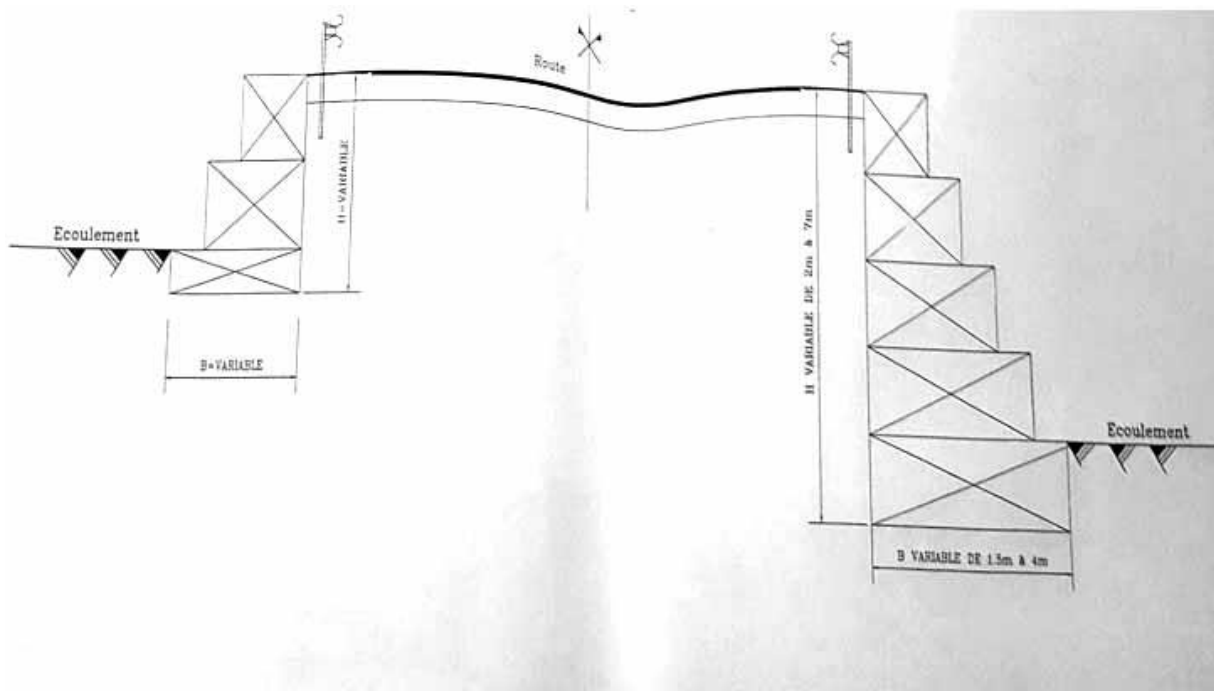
PROFIL TYPE DE MUR DE SOUTÈNEMENT DE LA ROUTE V1V2
